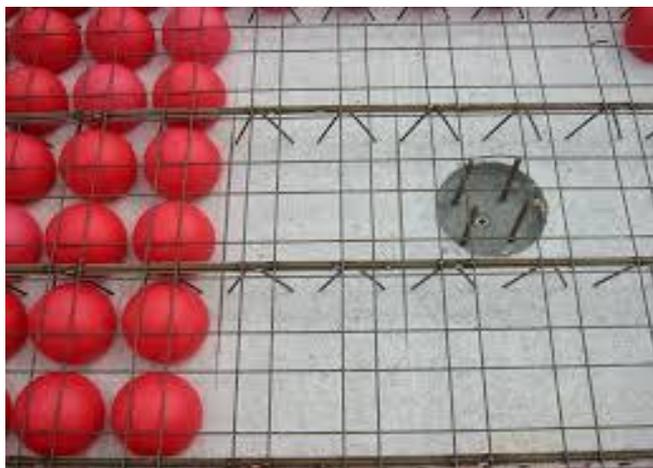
Плоское пустотное армированное бетонное перекрытие с двухмерной структурой, Дания
